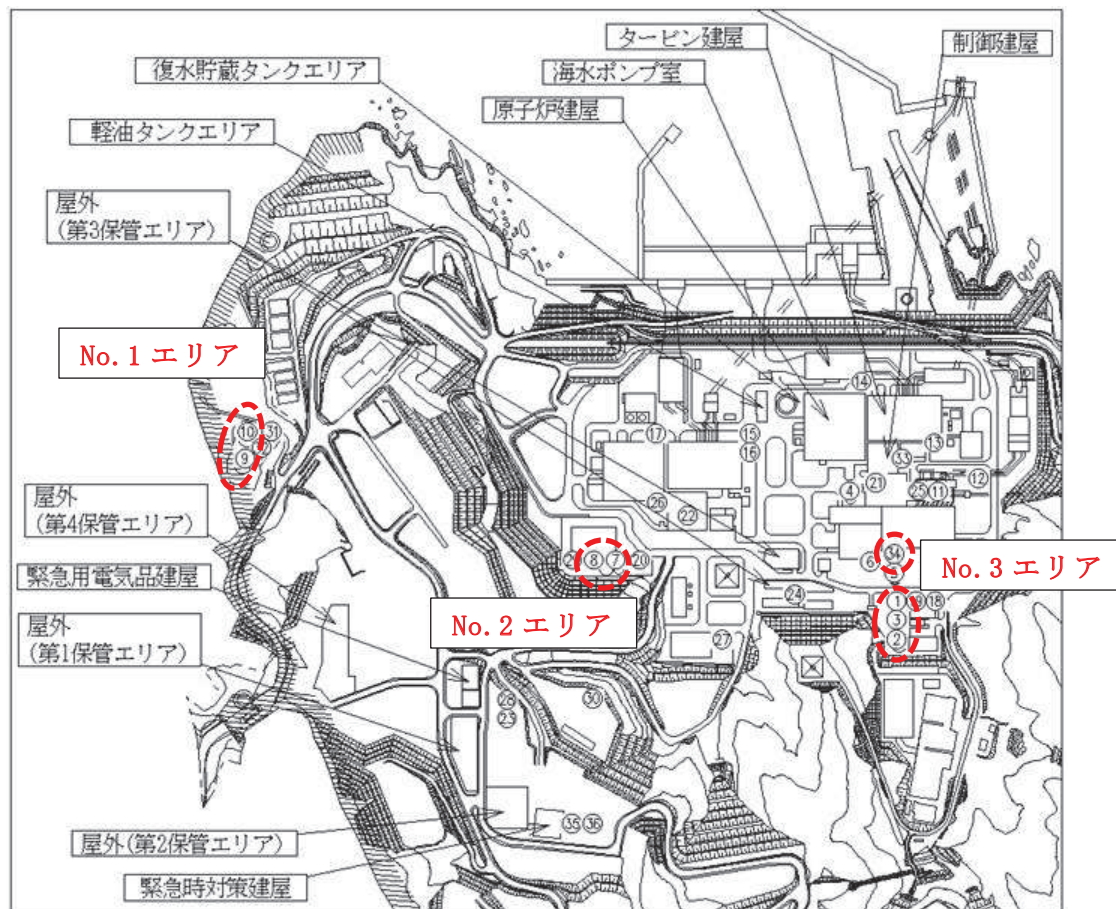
溢水影響評価の対象となる屋外タンク配置図
